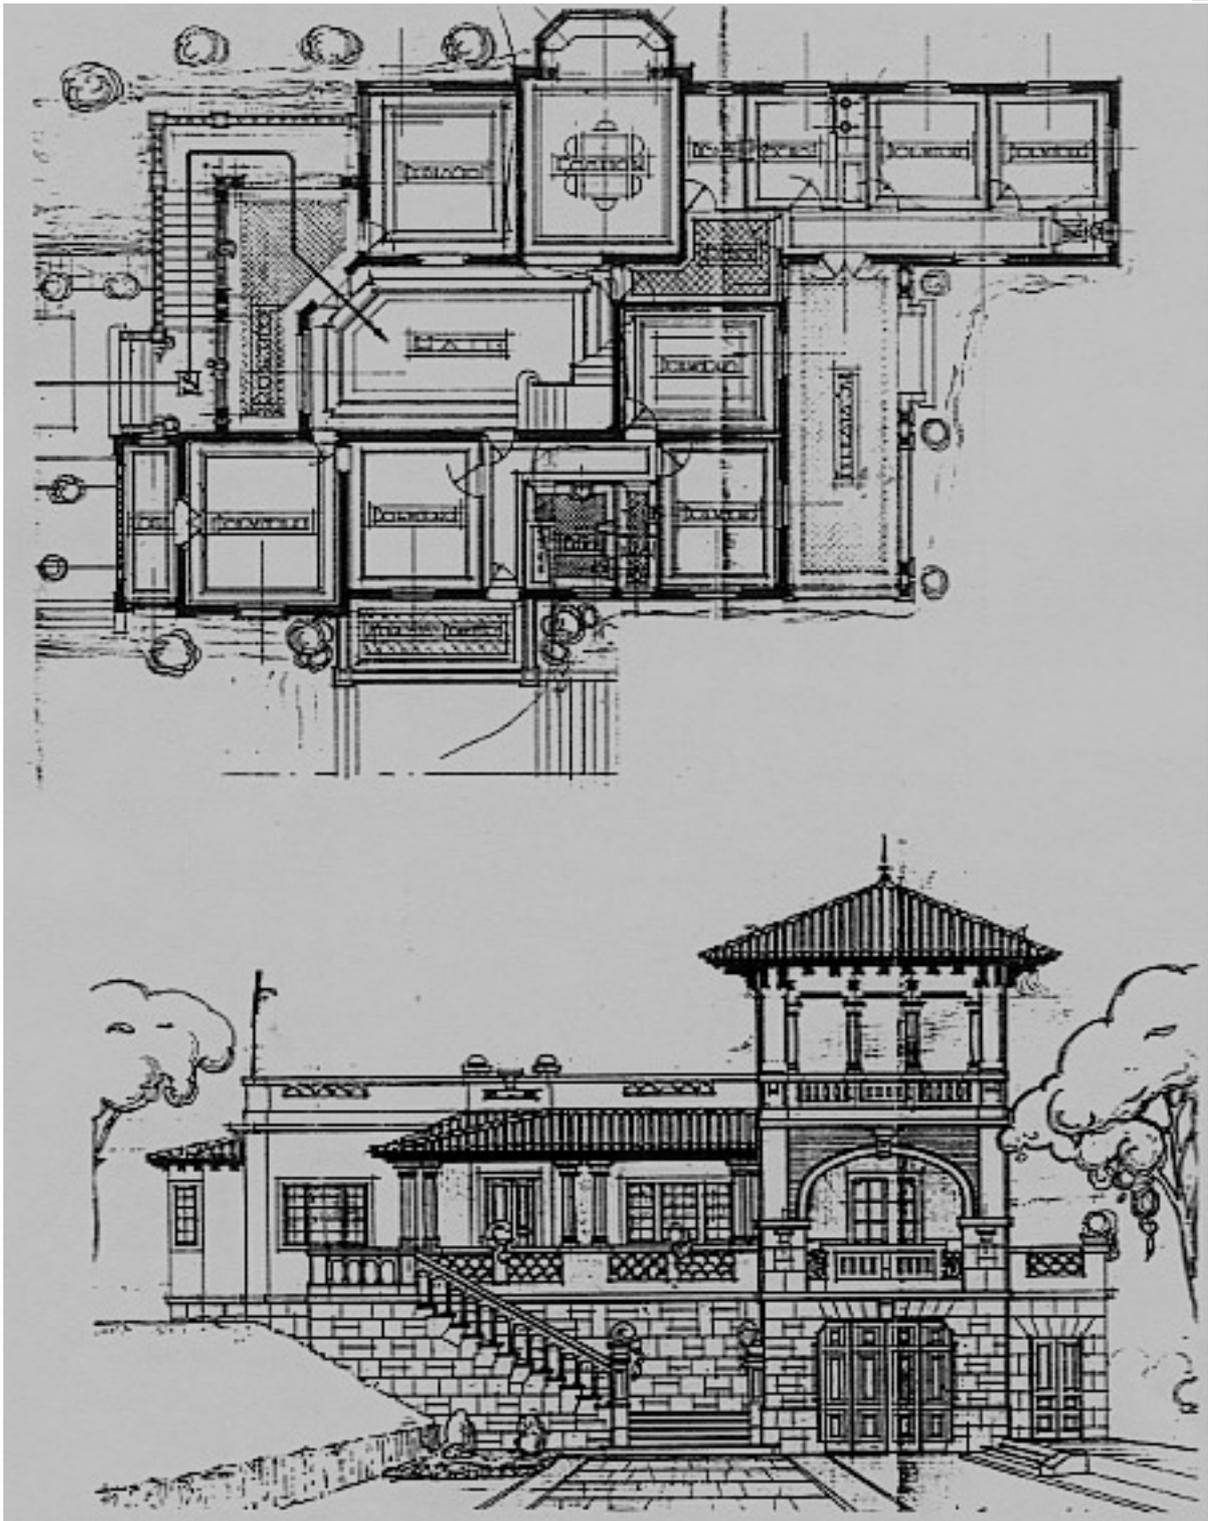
R. Masanet (1925). Villa Leonor. Carretera del Centro, 157; a) planta baja; b) alzado principal. AHP de LP: P. y O. Leg. 67; exp. 30.
